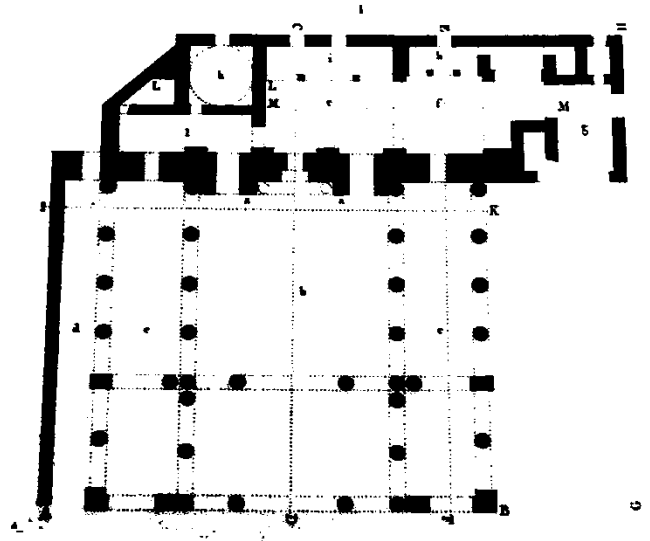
جامع الناصر محمد بالقلعة - مسقط أفقي
